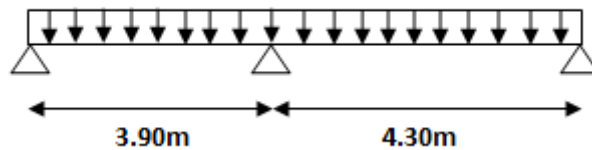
Schéma statique de la poutrelle type 1 à l'ELU
